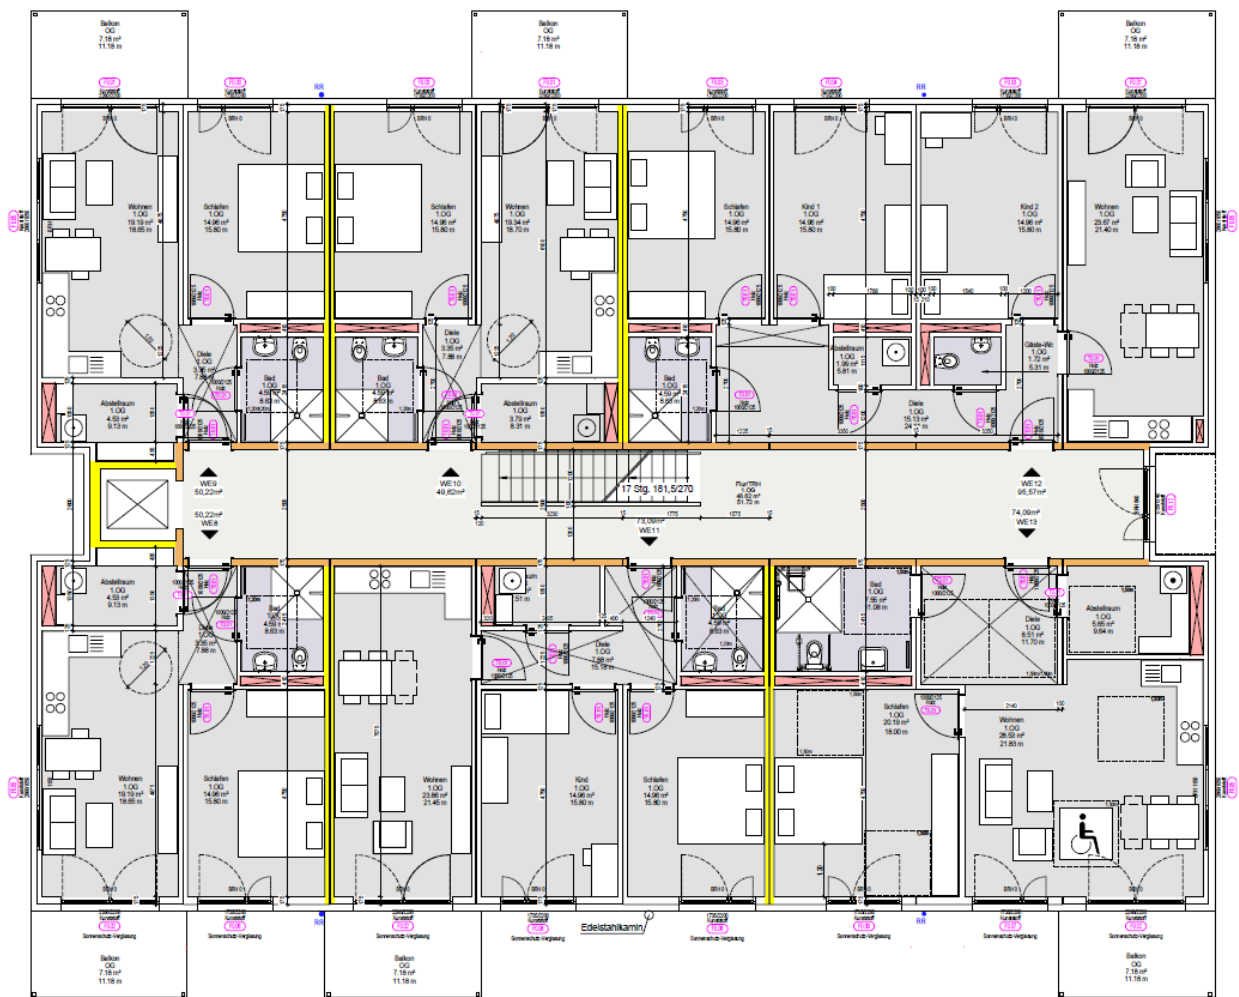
Grundriss des 1. Obergeschosses des Geschosswohnungsbaus in Raummodulbauweise (Stahlkonstruktion) in Dortmund, Deutschland (Bildrechte: ALHO Systembau GmbH)
